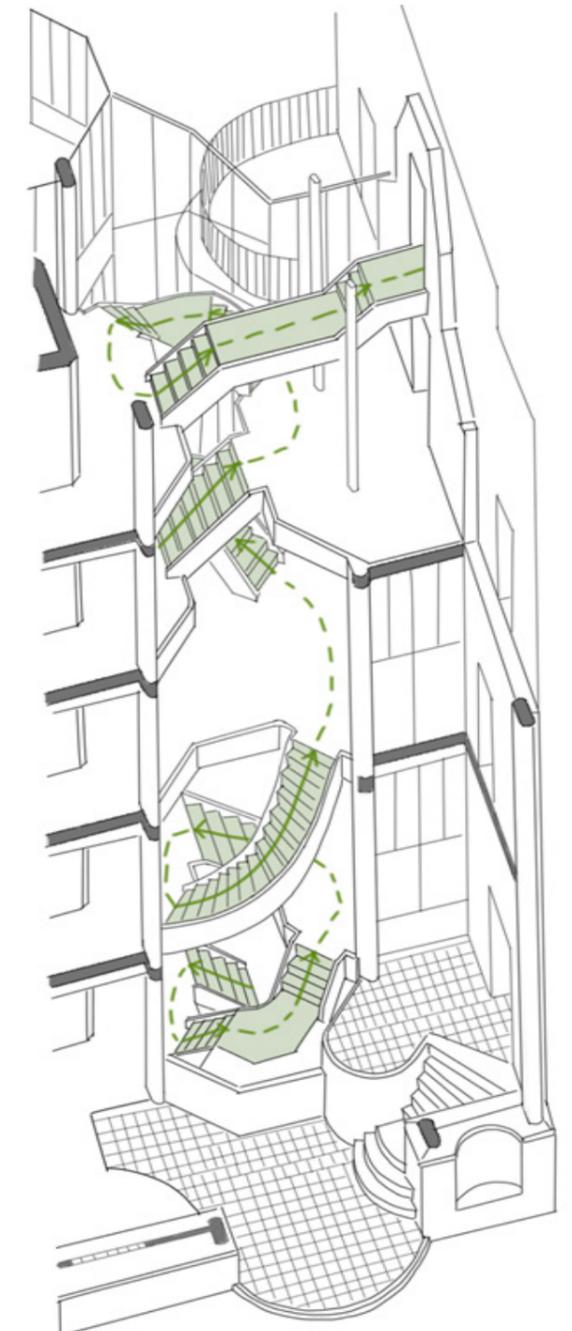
Situación del vestíbulo central en planta. Elaboración propia.
